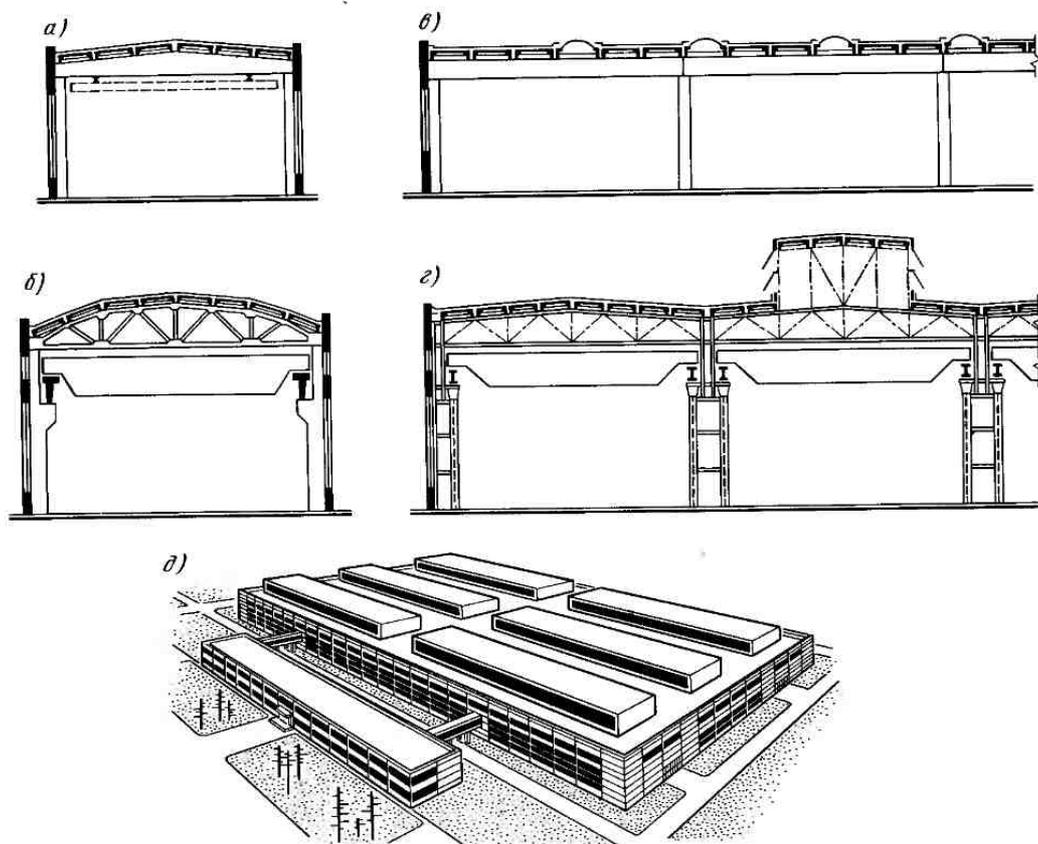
Основные типы одноэтажных промышленных зданий:
